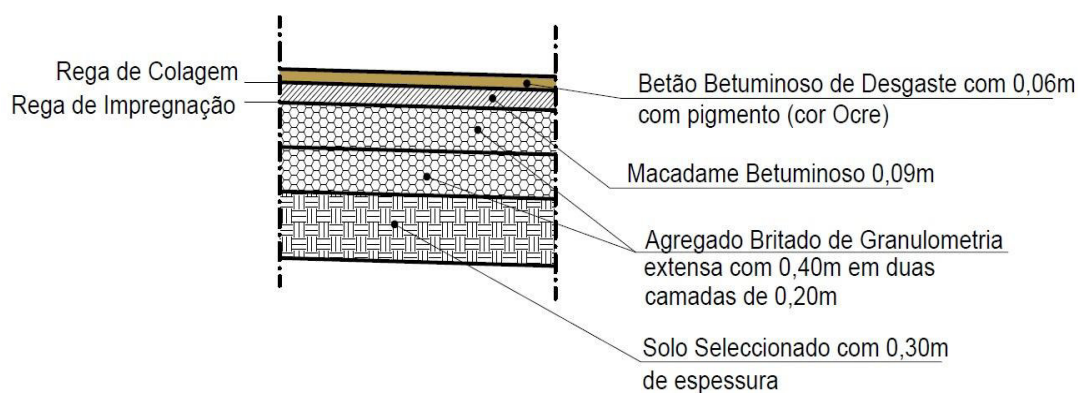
Pormenor construtivo do pavimento na Estrada de Benfica [76]
